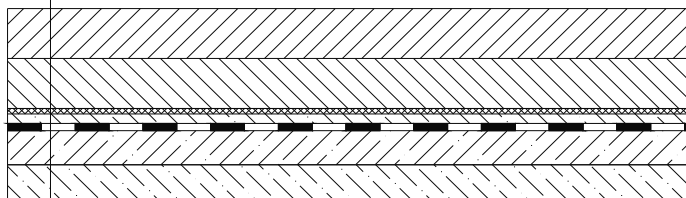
Конструкция дорожной одежды мостового полотна на мостах через реки Малая и Большая Каюковки (сталебетонные пролетные строения)
